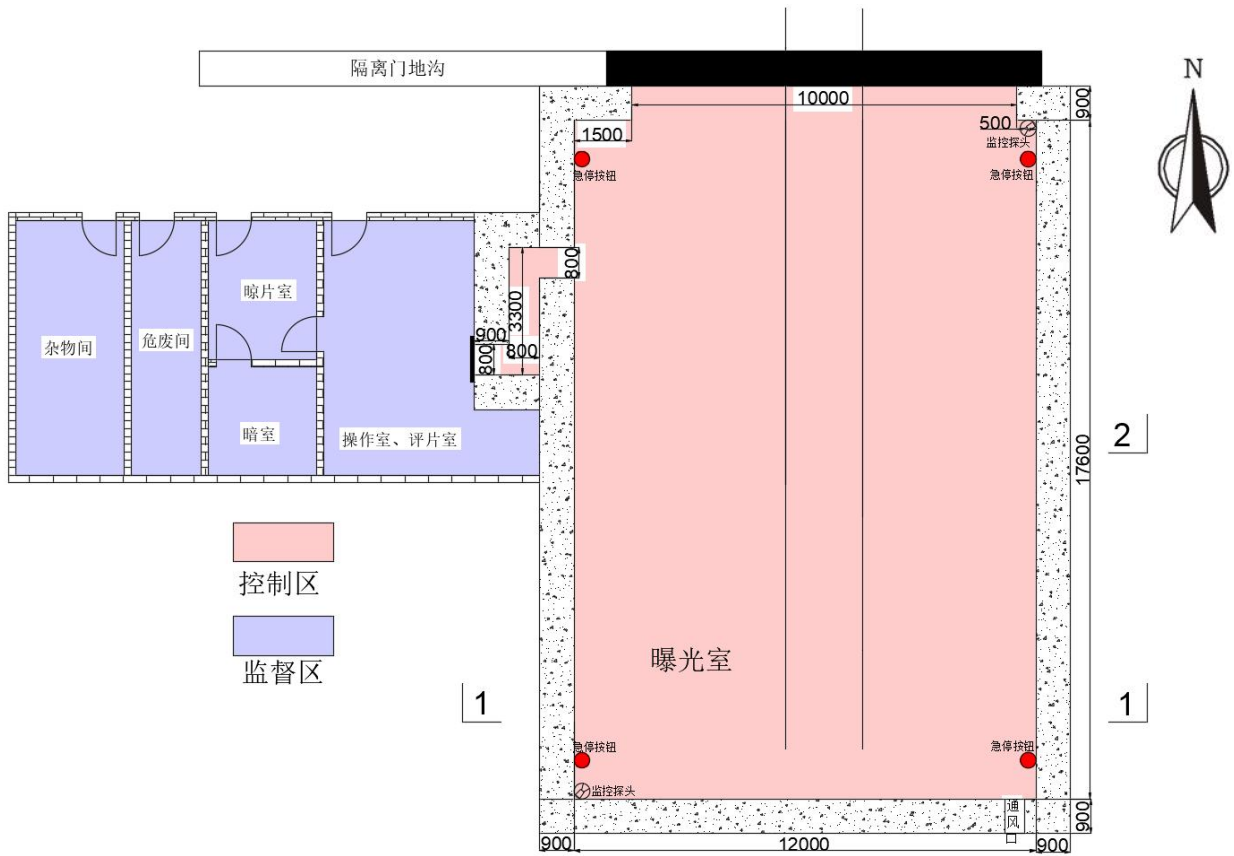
(a) 探伤室平面布置示意图 (单位: mm)
